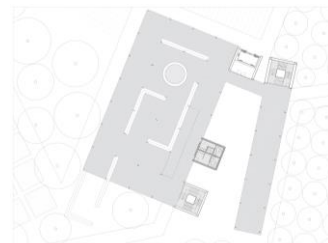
Planta do piso térreo (J.C. 2022; Folha 19)
